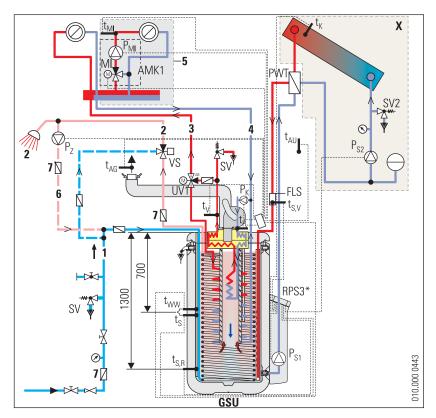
Impianto solare a pressione con GasSolarUnit (GSU)
